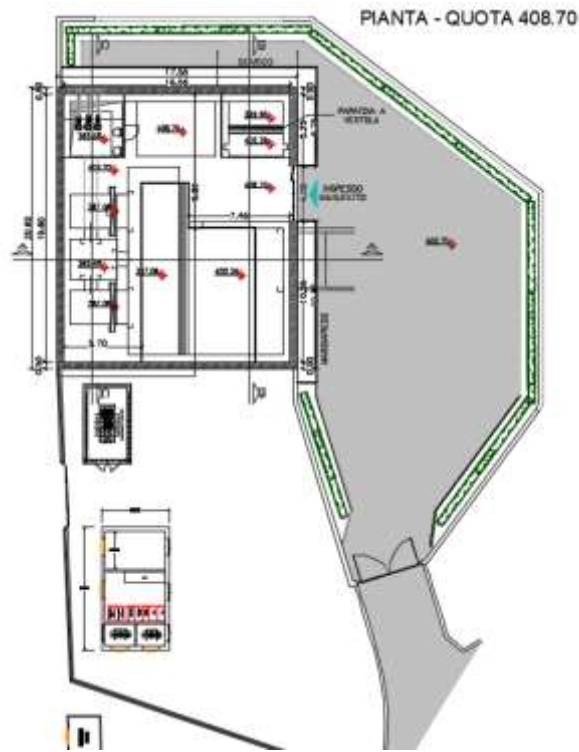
Planimetria piazzale quota +408.70m s.l.m
